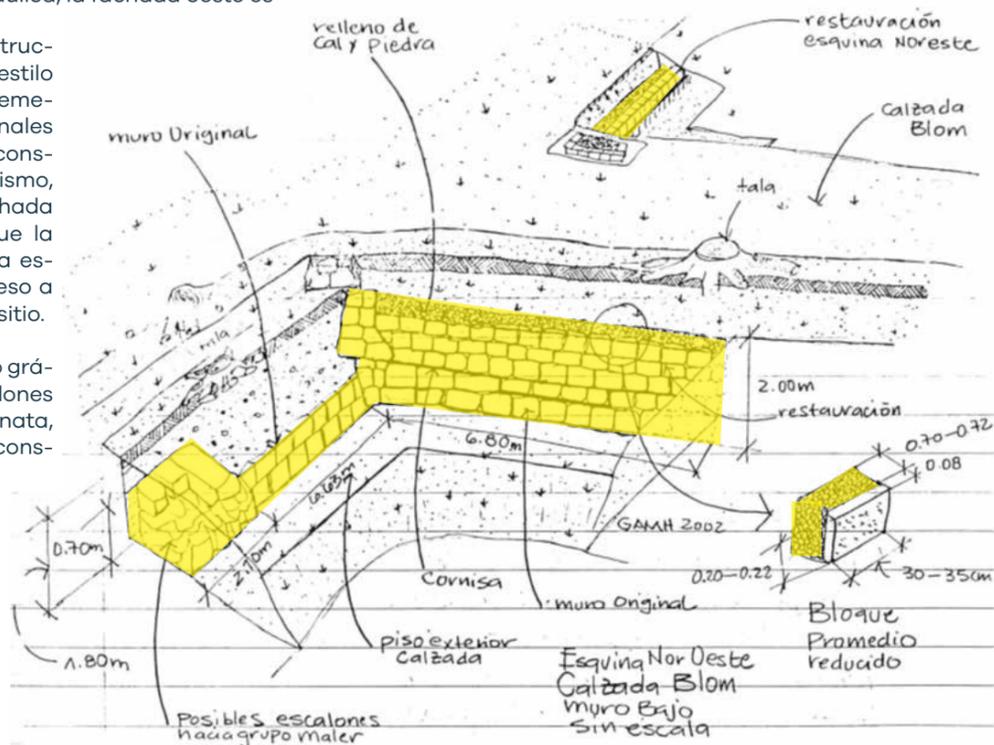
Calzada Blom Esquina nor- oeste de la calzada y su contacto constructivo con la fachada sur de la plataforma sustentación del Grupo Maler. Detalle de acabado de reconstrucción de fachada según el estilo faldón y remetimiento Dibujo: GAMH 2002
